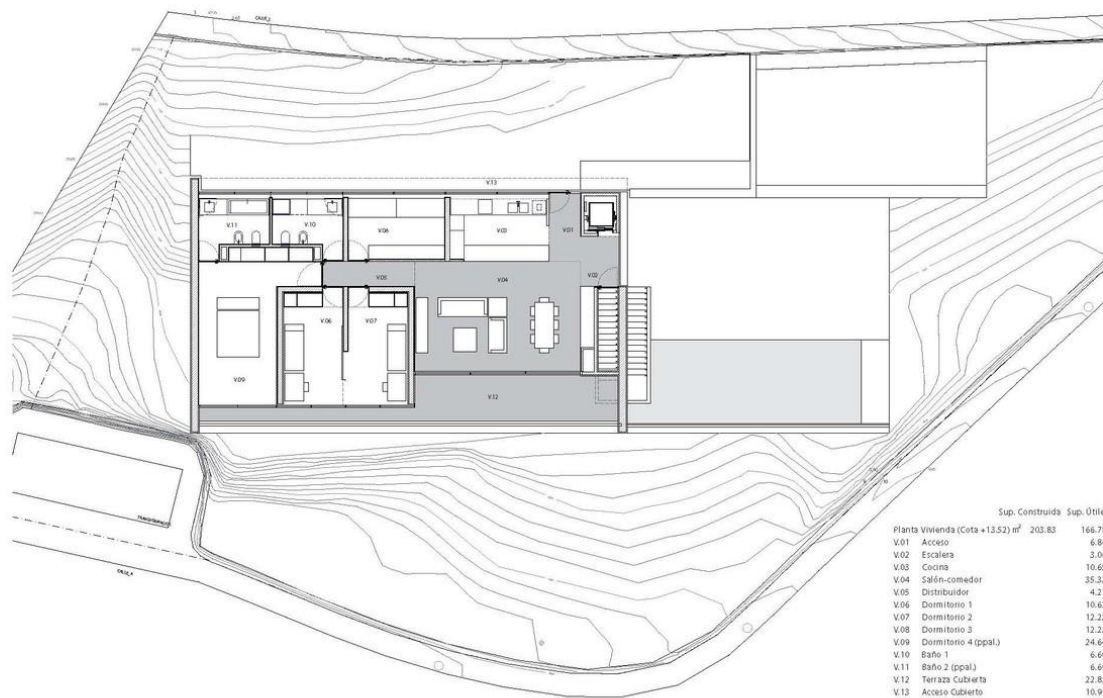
Plano planta vivienda (Cota +13.52m). Fuente: Fran Silvestre Arquitectos.
